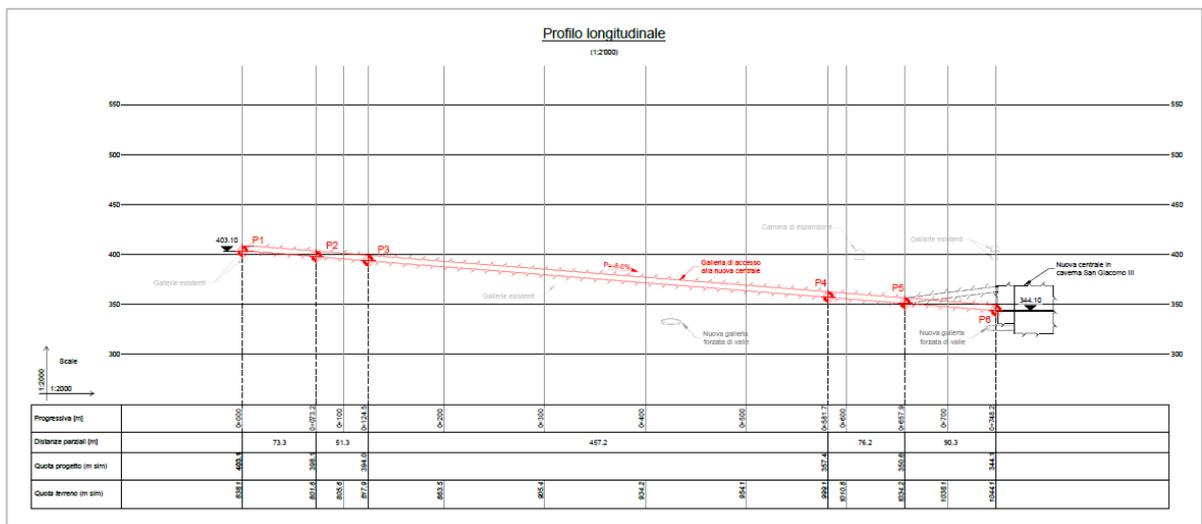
Galleria di accesso alla nuova centrale in caverna – profilo
